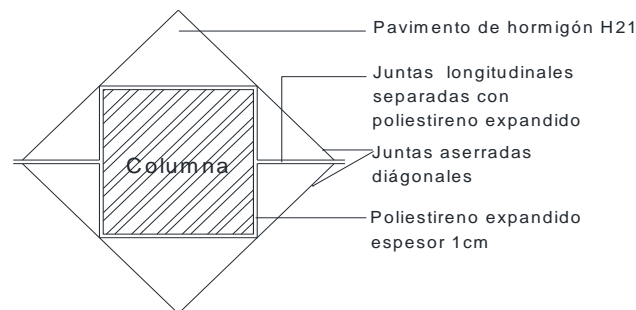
Detalle de juntas en el pavimento en uniones con columna
